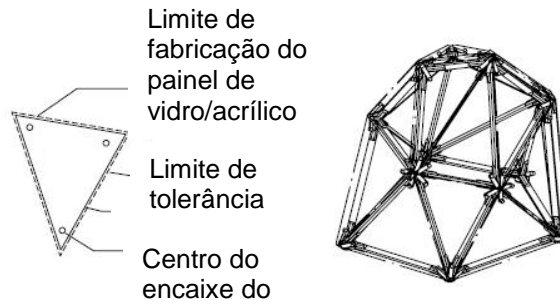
Figura I.II – Parâmetros do painel de vidro e instalação dos painéis numa estrutura totalmente montada (Shea et al., 2005: 23).
